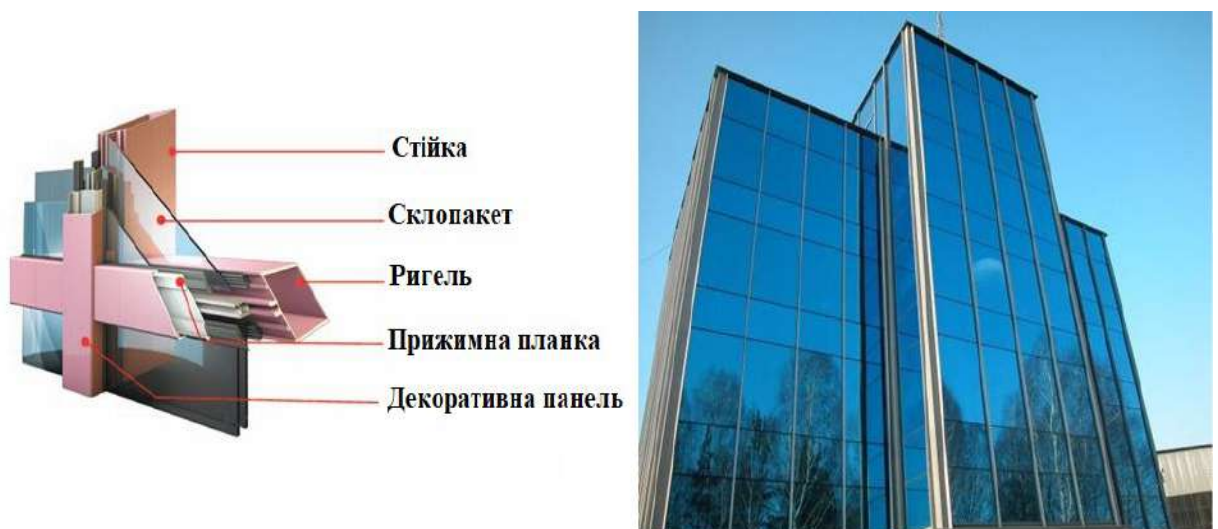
Стійко-ригельна скляна фасадна система та приклад змонтованого фасаду будівлі [12]
